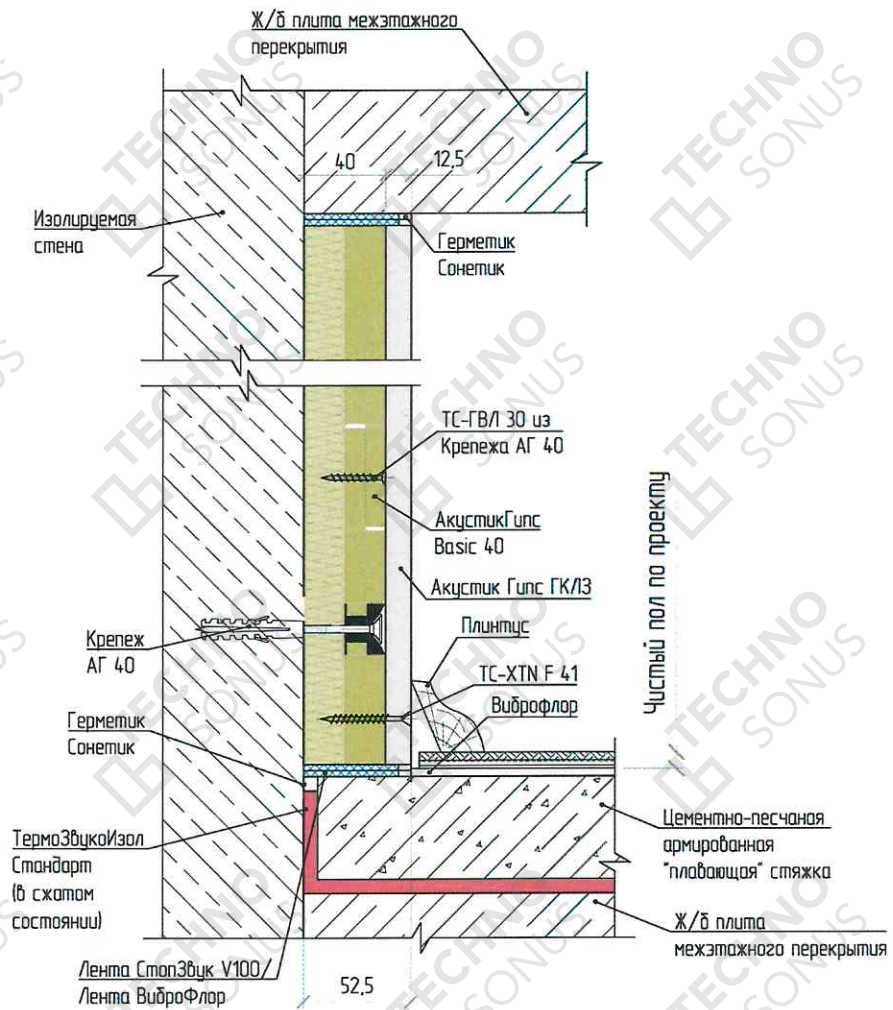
Примыкание облицовки стены «Слим А» к «плавающей» стяжке пола и к плите перекрытия
